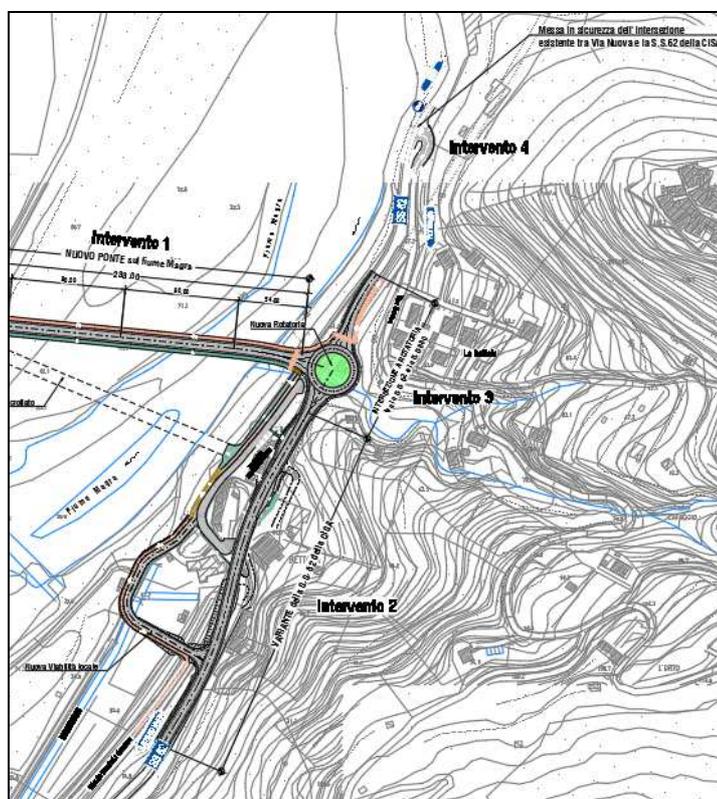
Planimetria interventi realizzazione variante SS62 “Cisa”
